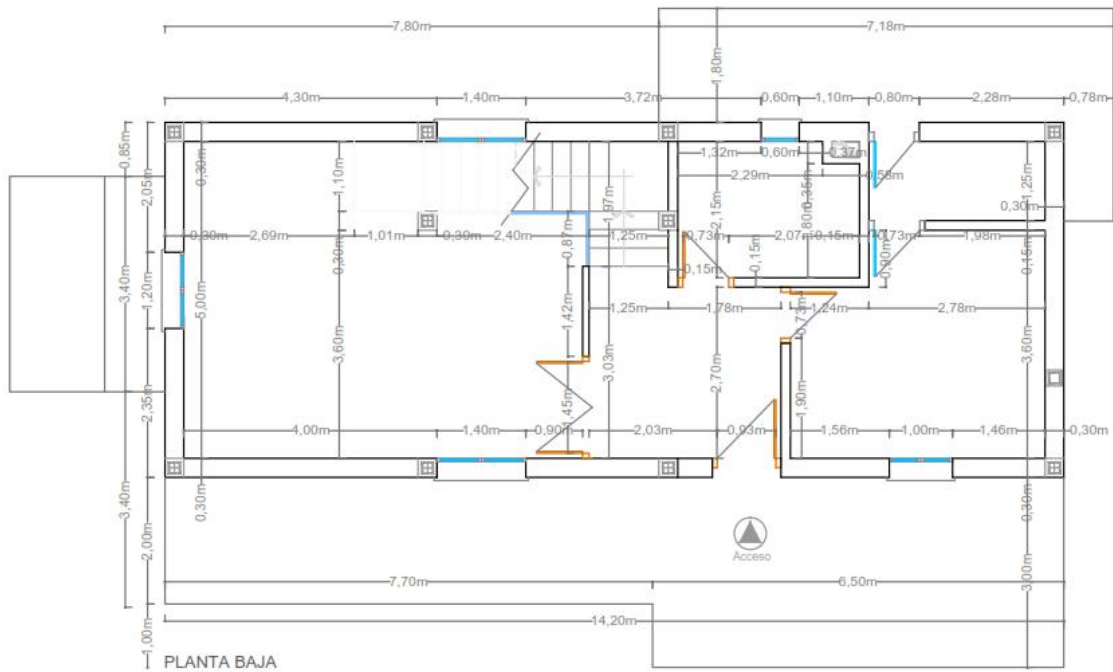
Plano acotado de la planta baja del inmueble objeto.
